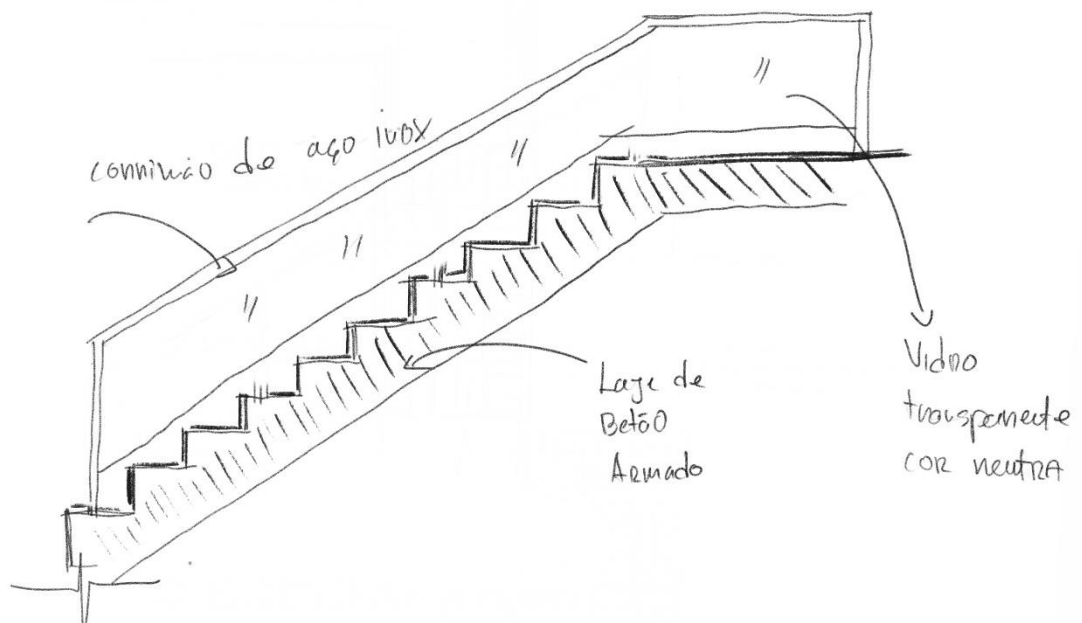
Pormenor construtivo da Escadaria exterior em corte
